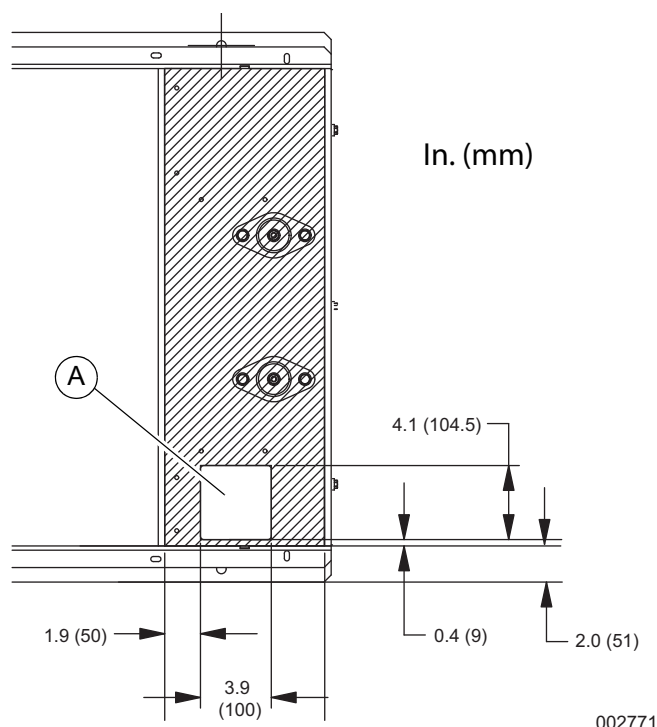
Plano de instalación, detalle del área de paso de tuberías (típico)
